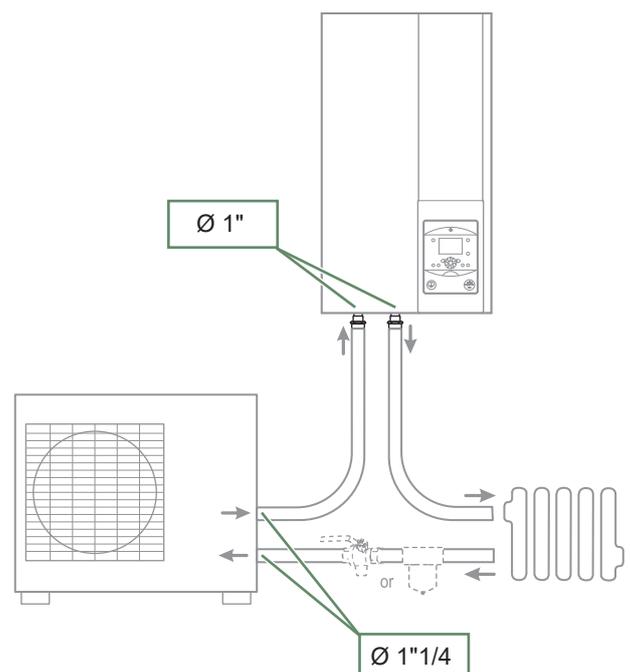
Durchmesser der Anschlussstücke der Rohrleitungen
